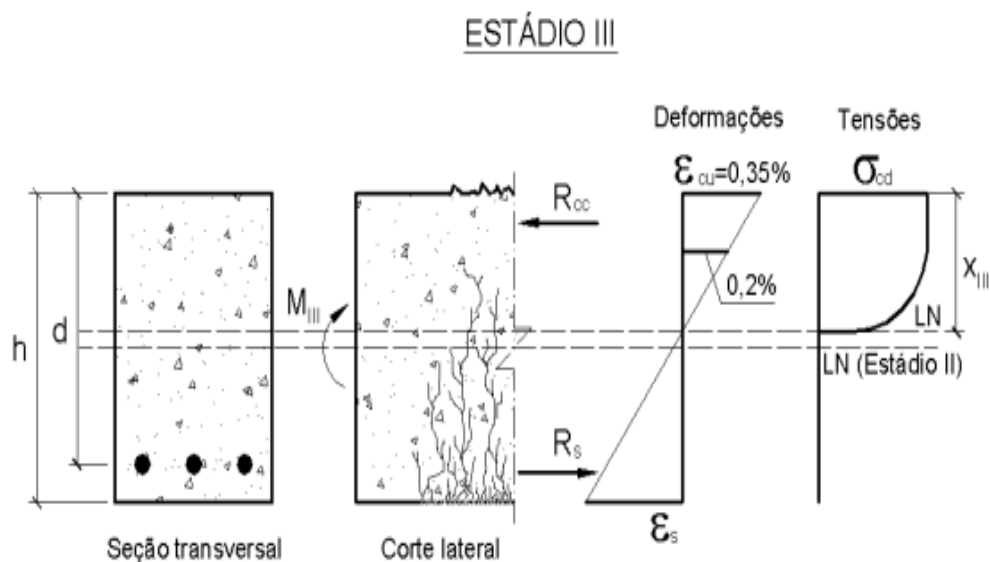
ESTÁDIO III DE FISSURAÇÃO
